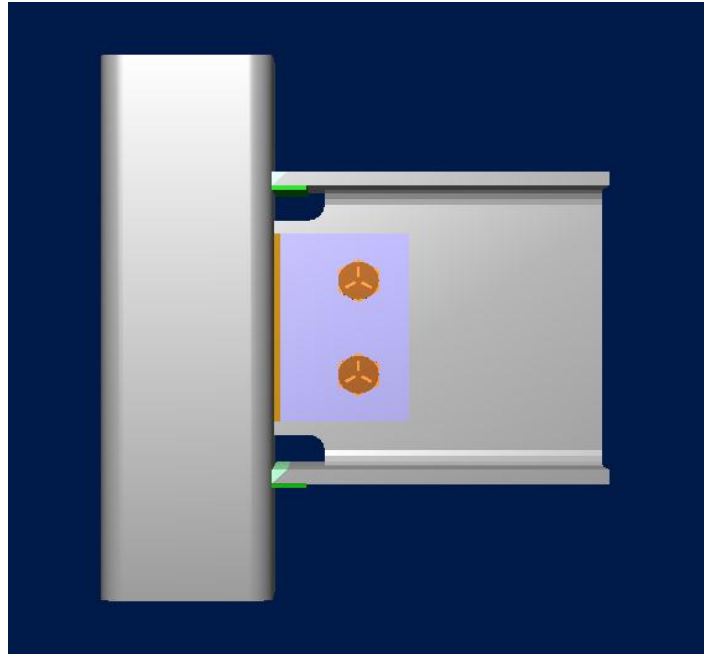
Conexión de Viga a Columna W10x12 – Col Hss 7x5x1/2
